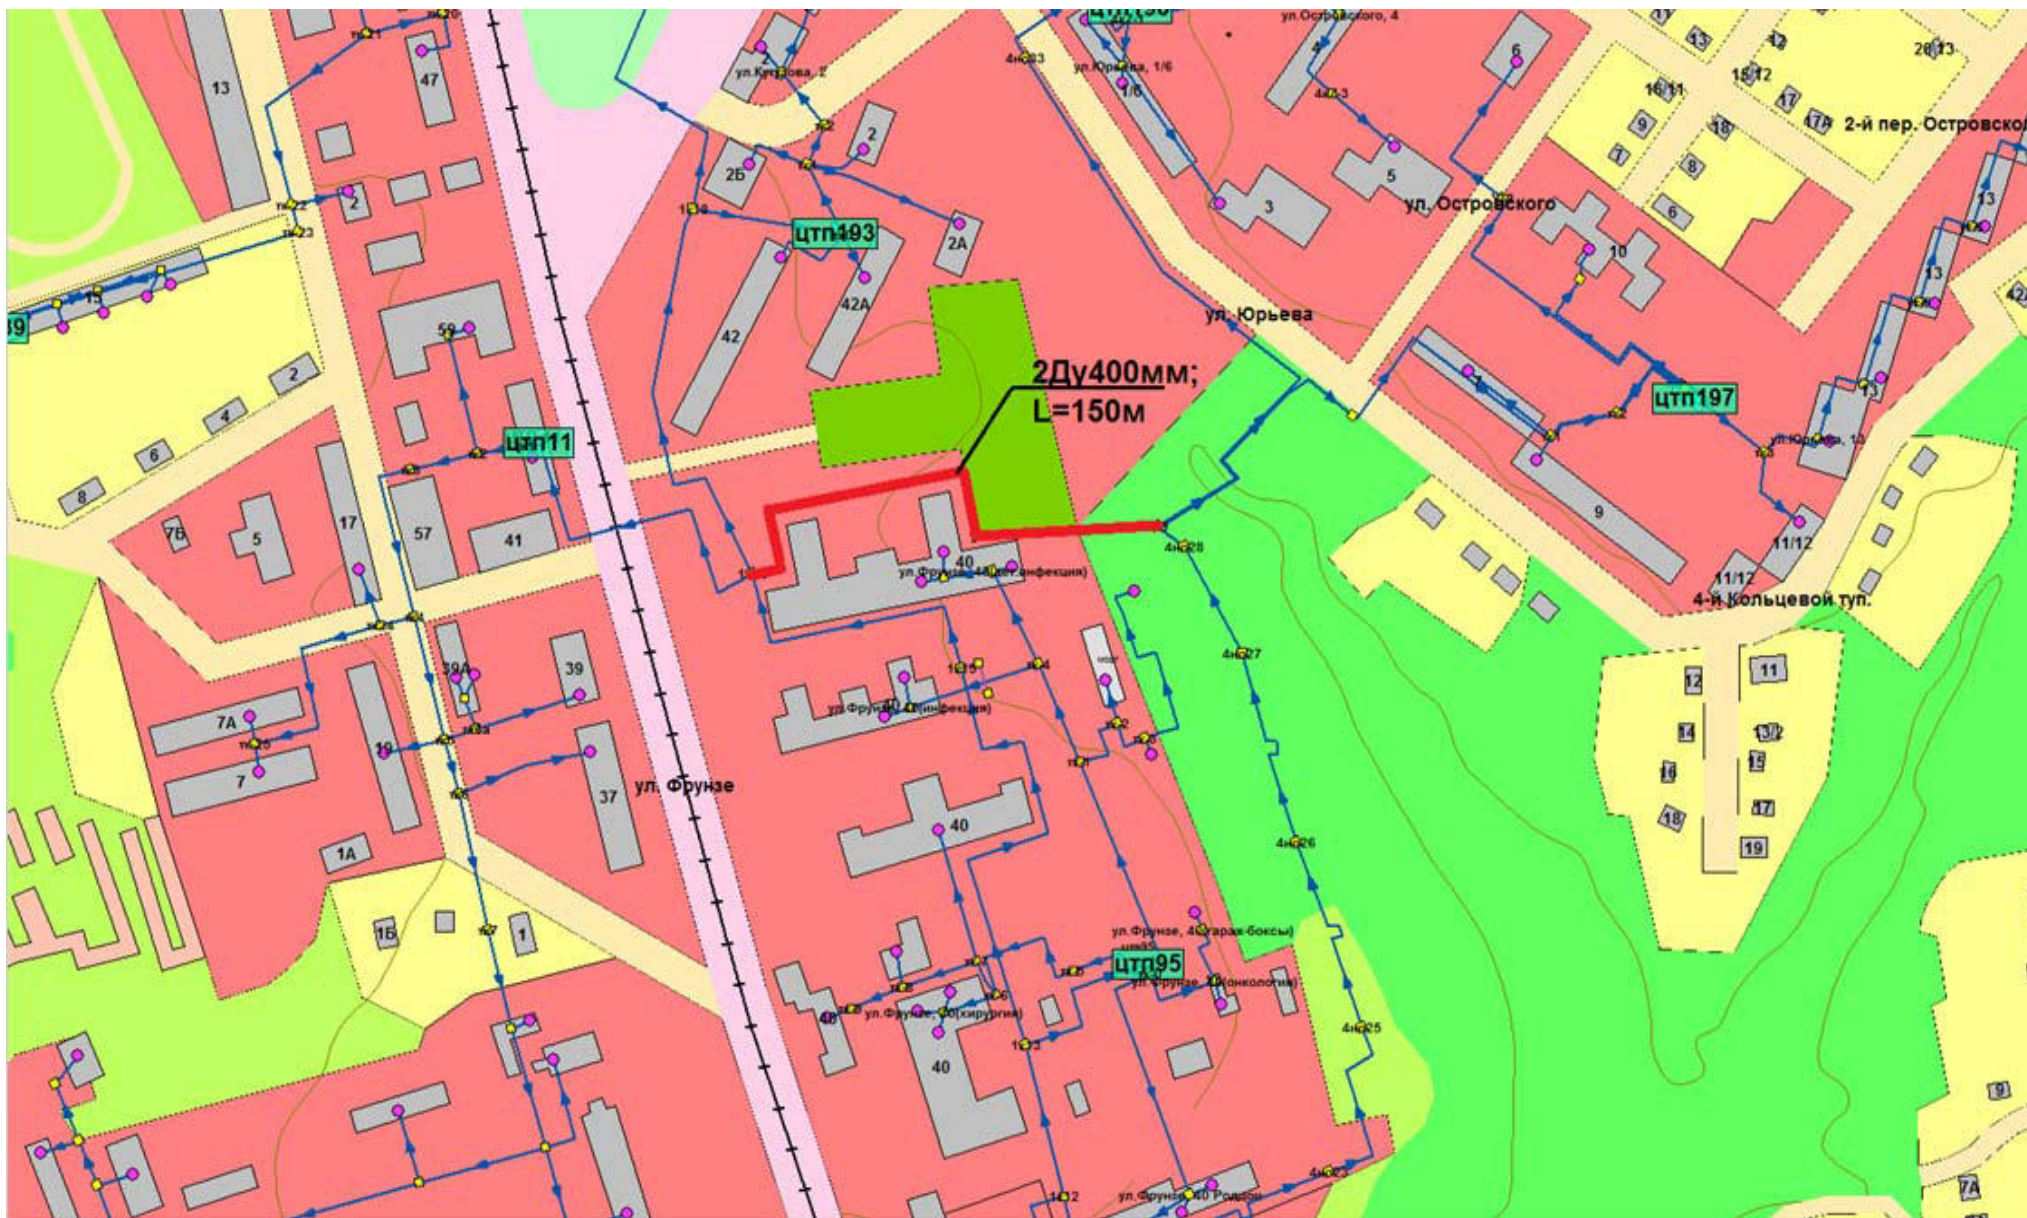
Перемычка от 1к16 до тепловой сети №4
